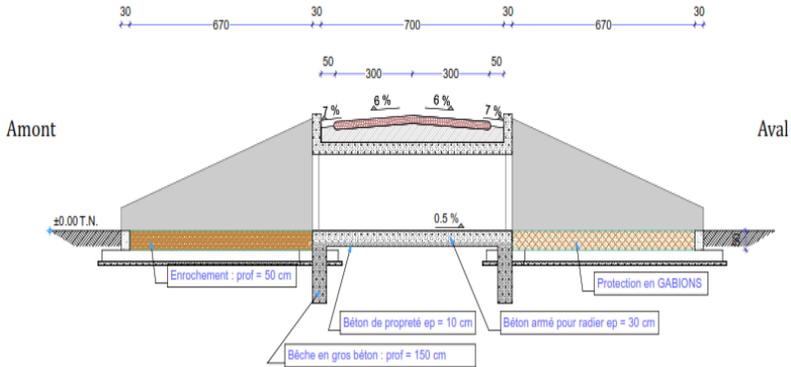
Coupe transversale de l'ouvrage de franchissement
